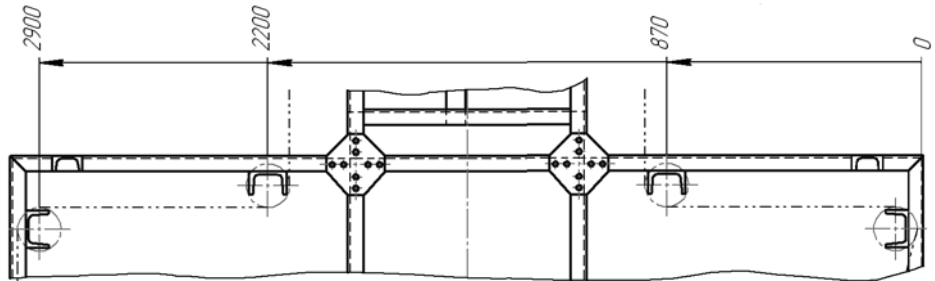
Простановка линейных размеров с общей размерной линией
